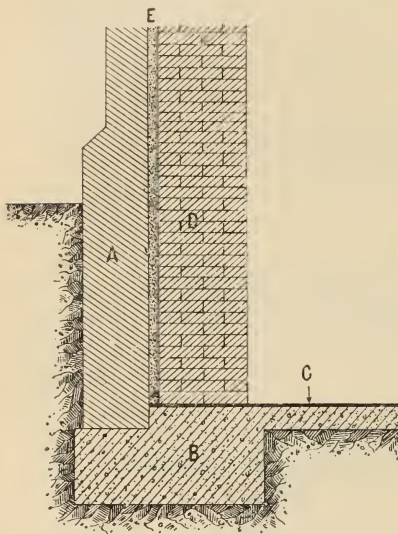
Fondation ordinaire (d'après Nussbaum).
